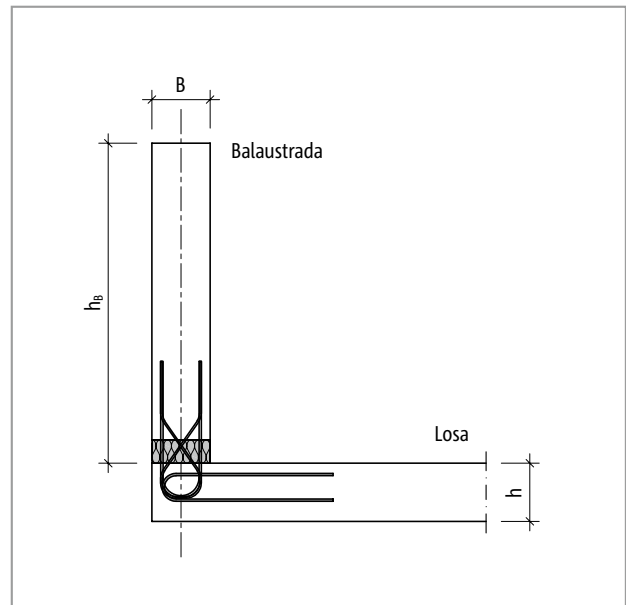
Schöck Isokorb® T tipo A: Sistema estático
